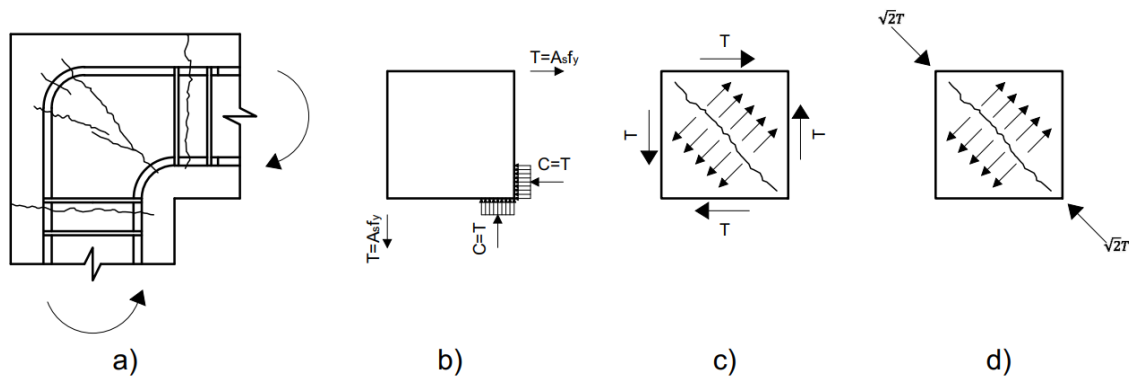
a) Grietas típicas. b) Fuerzas internas. c) Grietas debida a cortante. d) Grieta por compresión diagonal por deterioro de adherencia.
